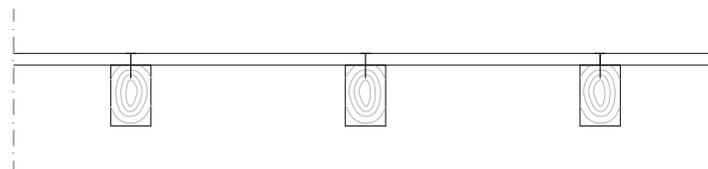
Forjado de revoltón y viguetas de madera de la construcción Qp9-191.
